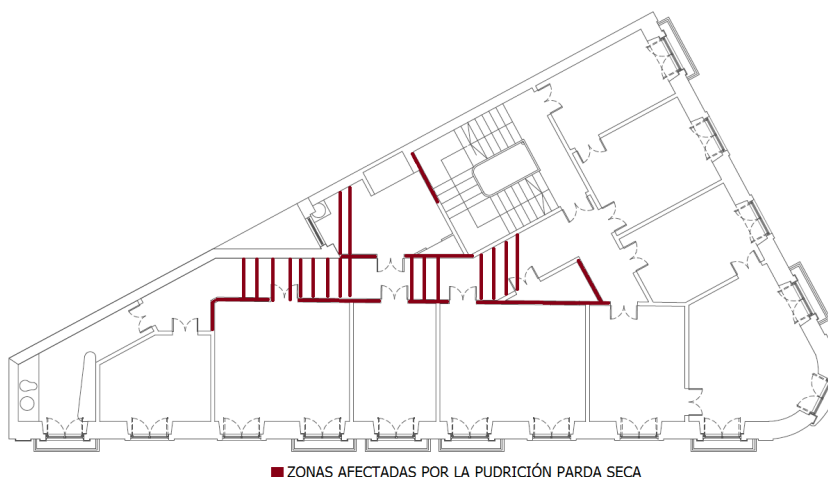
Esquema en planta de las piezas de madera afectadas por la pudrición parda seca (pudrición cubica)
